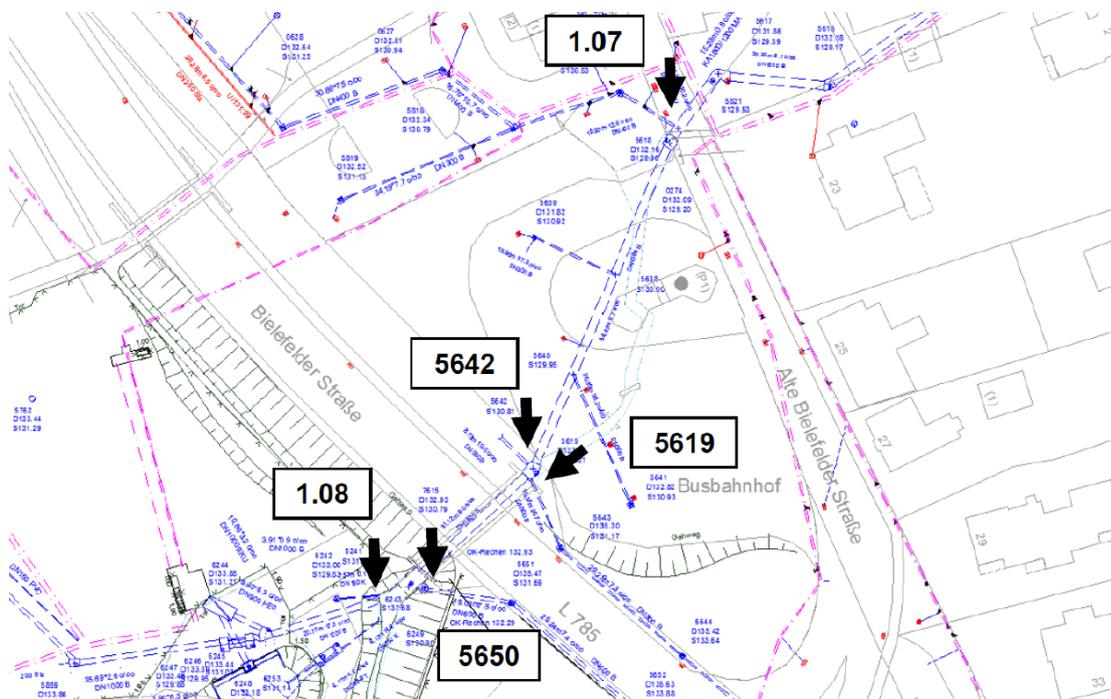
Übersicht der relevanten Einleitungsstellen im Lageplan
